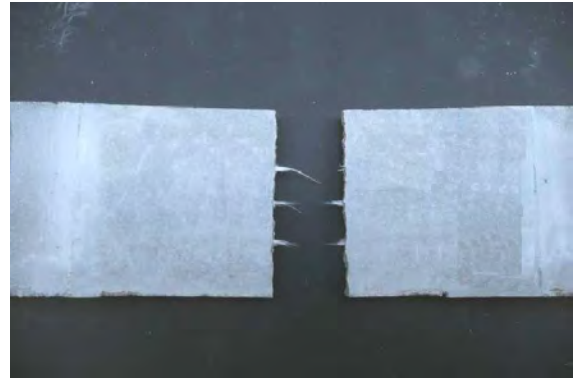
Betonprobekörper nach dem Zugversuch, VET ARG mit Beschichtung (Bsp.: VET ARG P1), 360 d, Wasserlagerung, 60 °C
